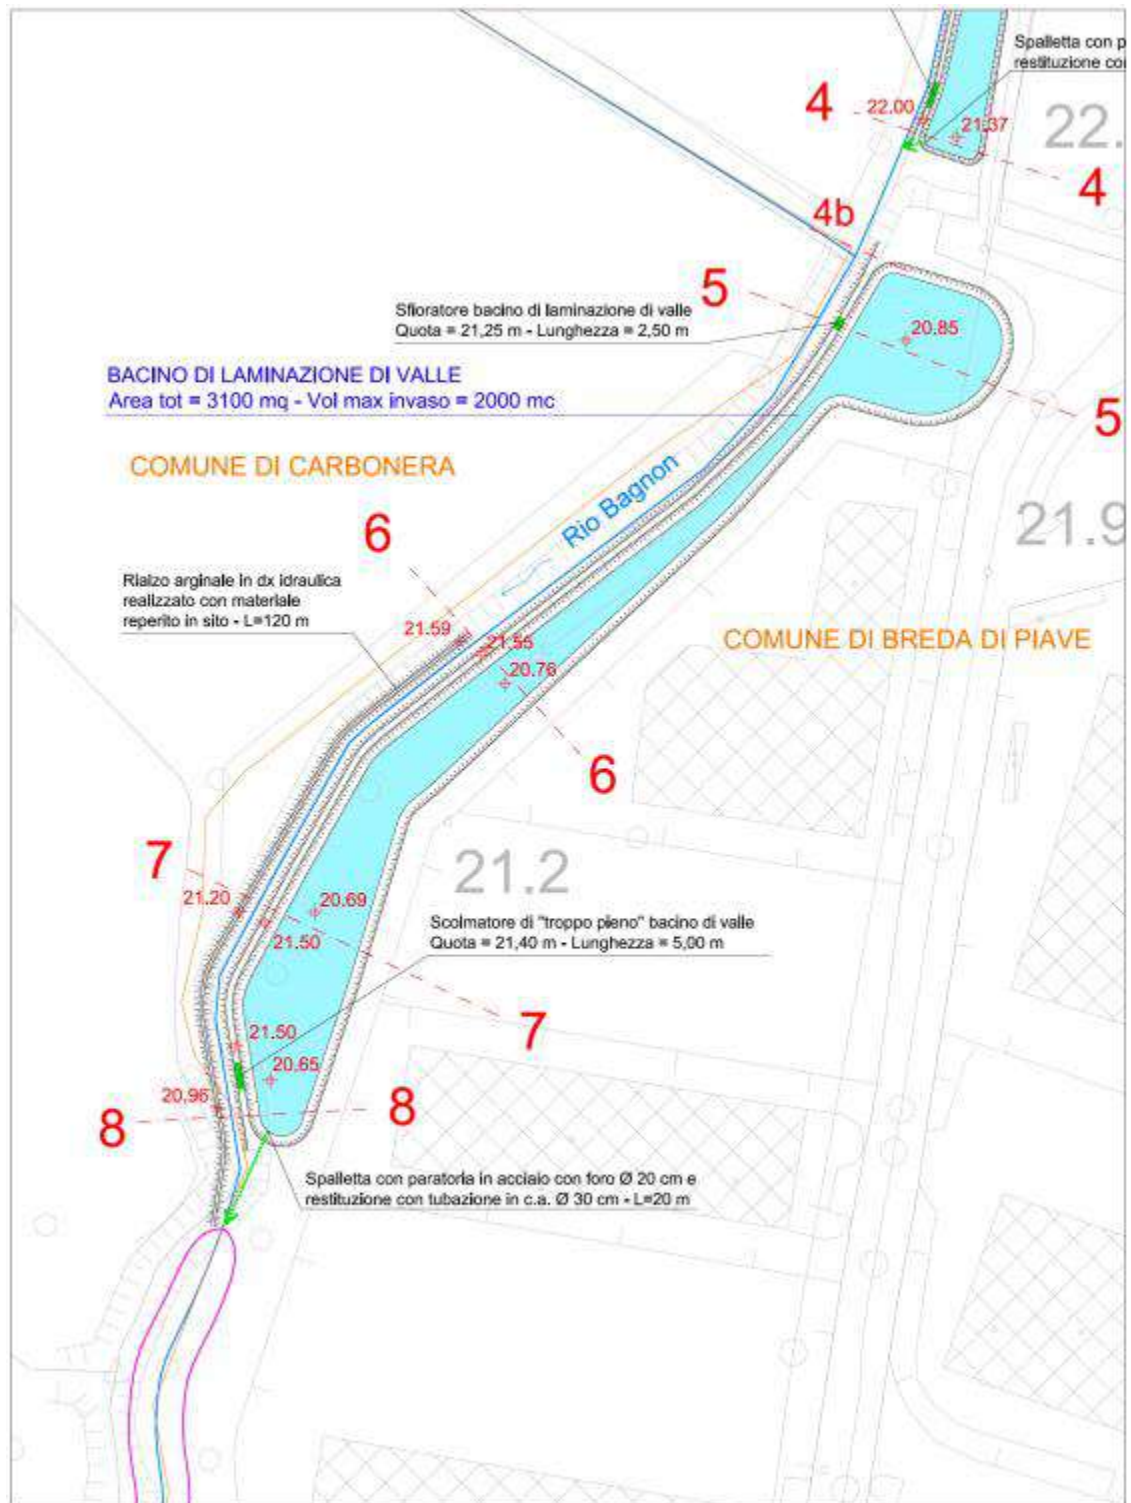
Planimetria del Bacino di laminazione di valle
